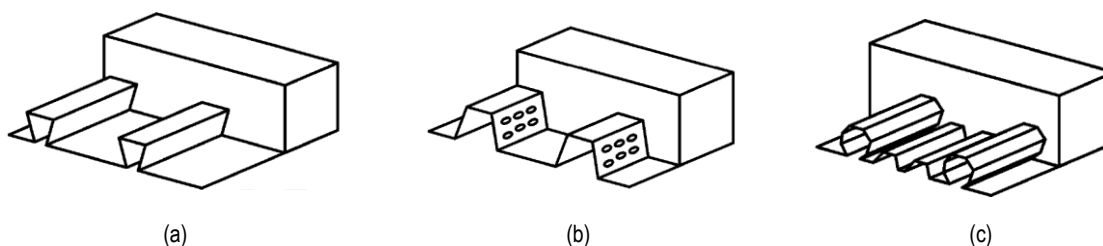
Configurações de chapas perfiladas de lajes mistas: (a) perfil reentrante; (b) perfil trapezoidal; (c) perfil ómega
